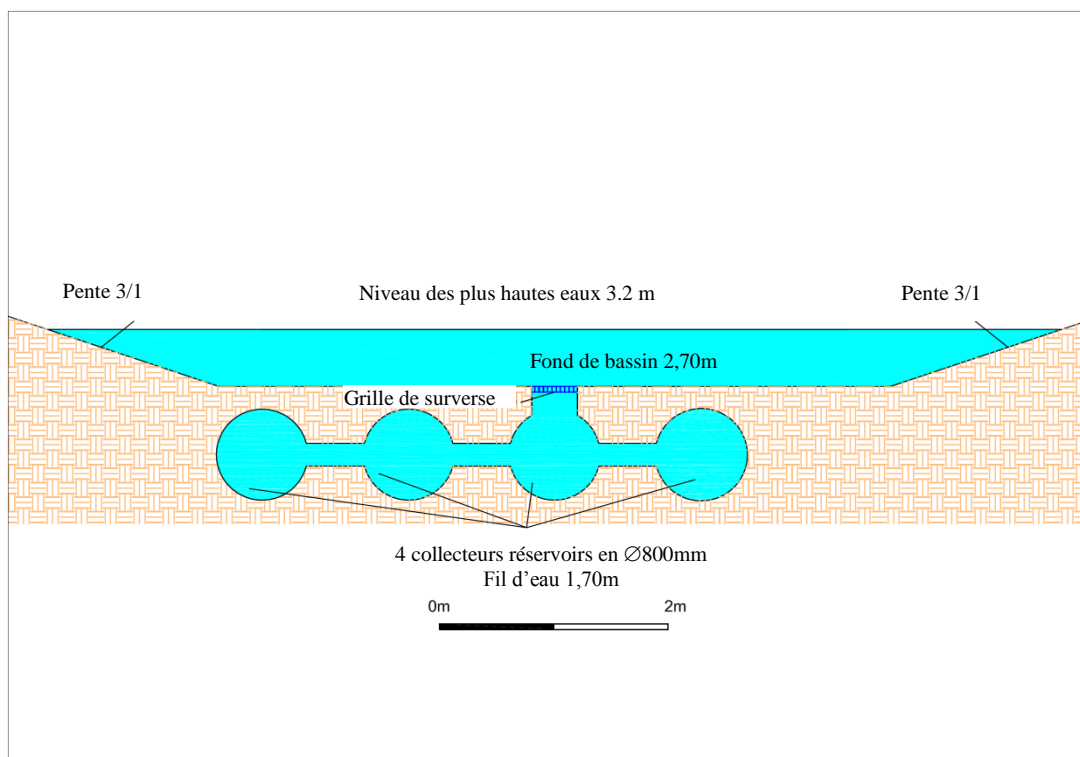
coupe en travers de l'ouvrage de rétention en cote NGF 69 (ECR, 2014)
